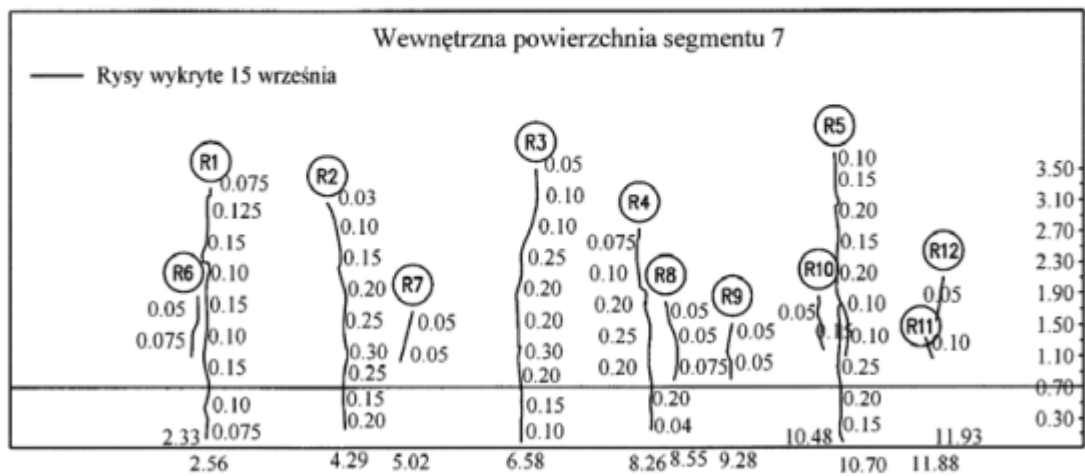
Seinän 6 halkeamien sijainnit ja mitatut halkeamaleveydet. [60]
